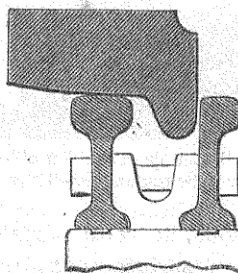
Tramways de Lille. Section montrant la disposition des rails pour les wagons de chemins de fer. Echelle 1/5.
